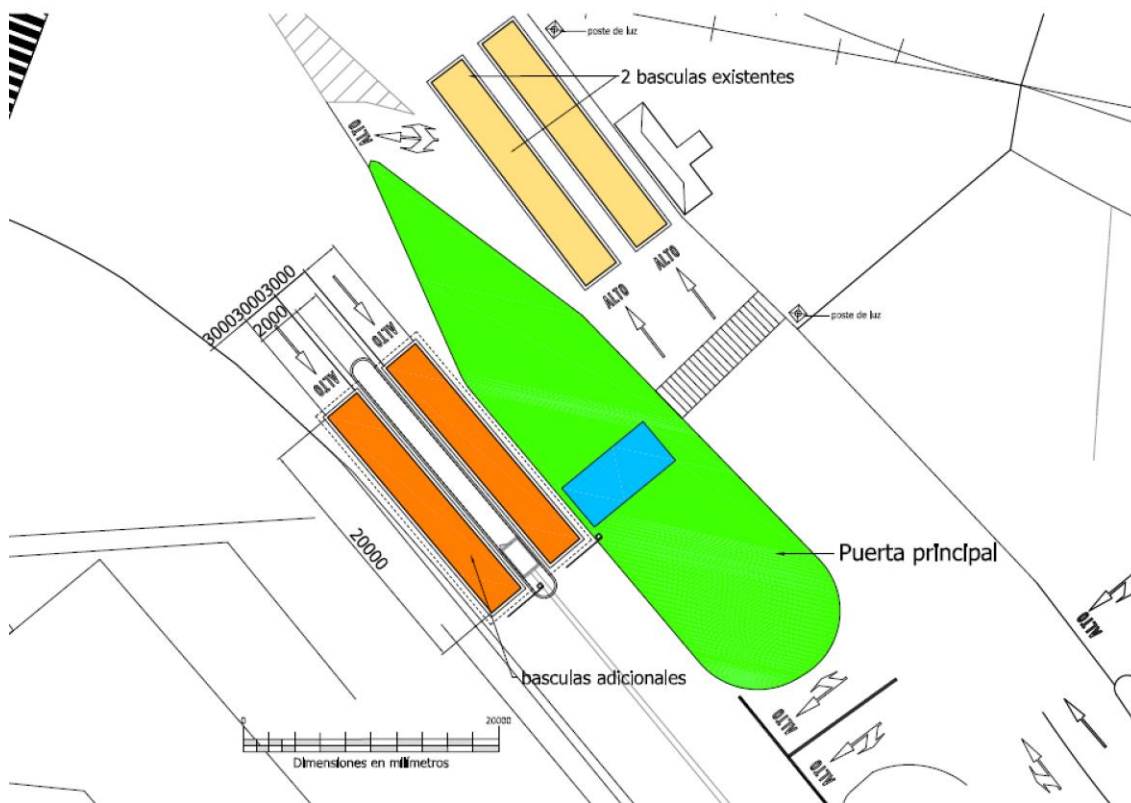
Diseño de la instalación de la puerta principal- Puerta – 1 Estación 1
